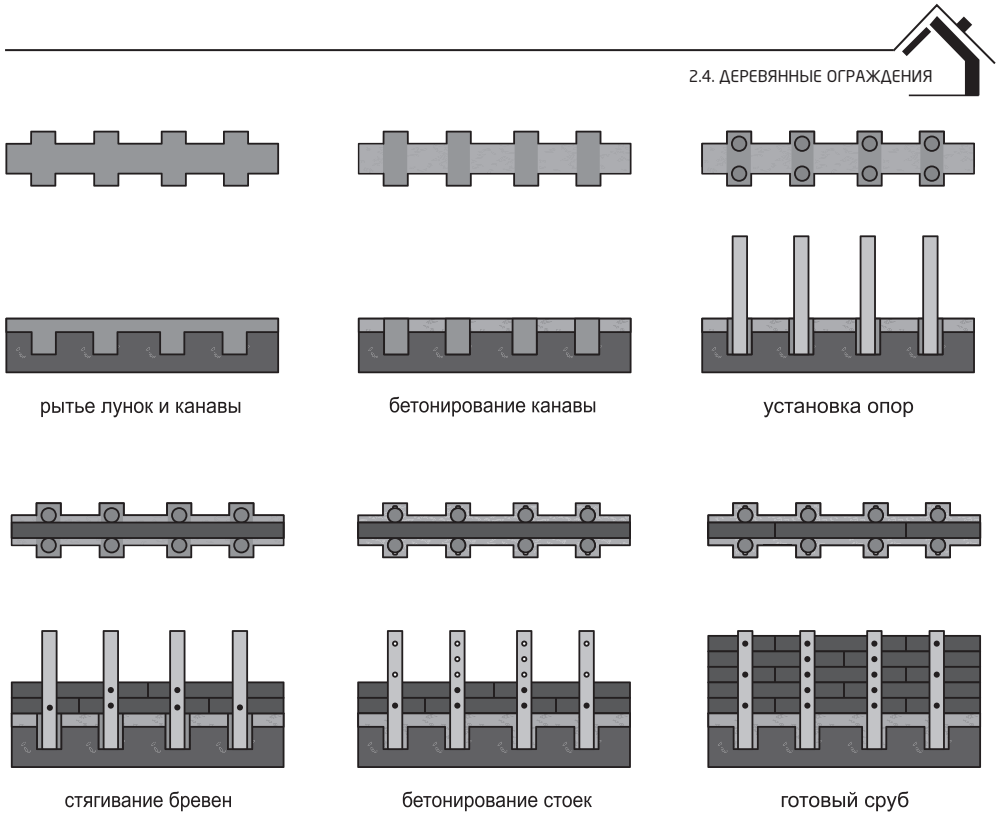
Монтаж сруба на свдвоенных опорах
